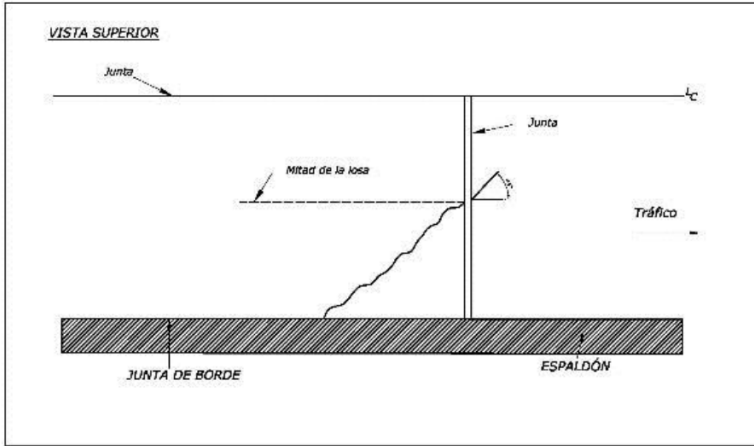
Esquema Grieta de Esquina- Pavimento Rígido
